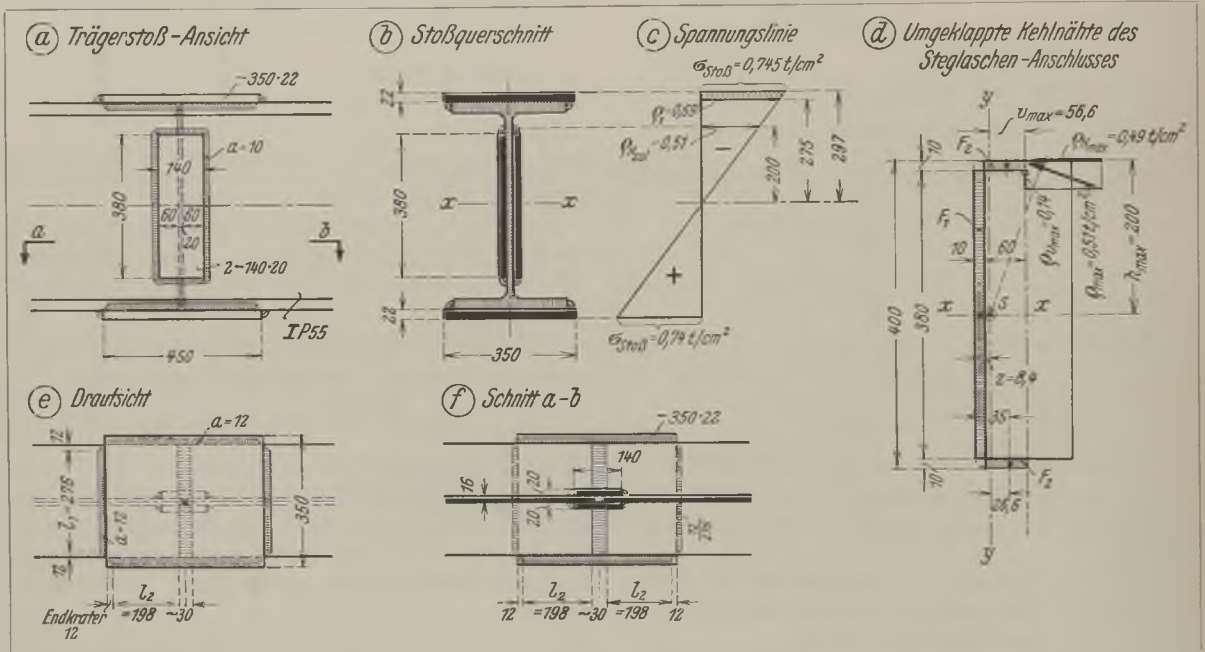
Biegeester Stoß eines IP 55 mittels voller Stumpfschweißung, Flansch- und Steg laschen.
